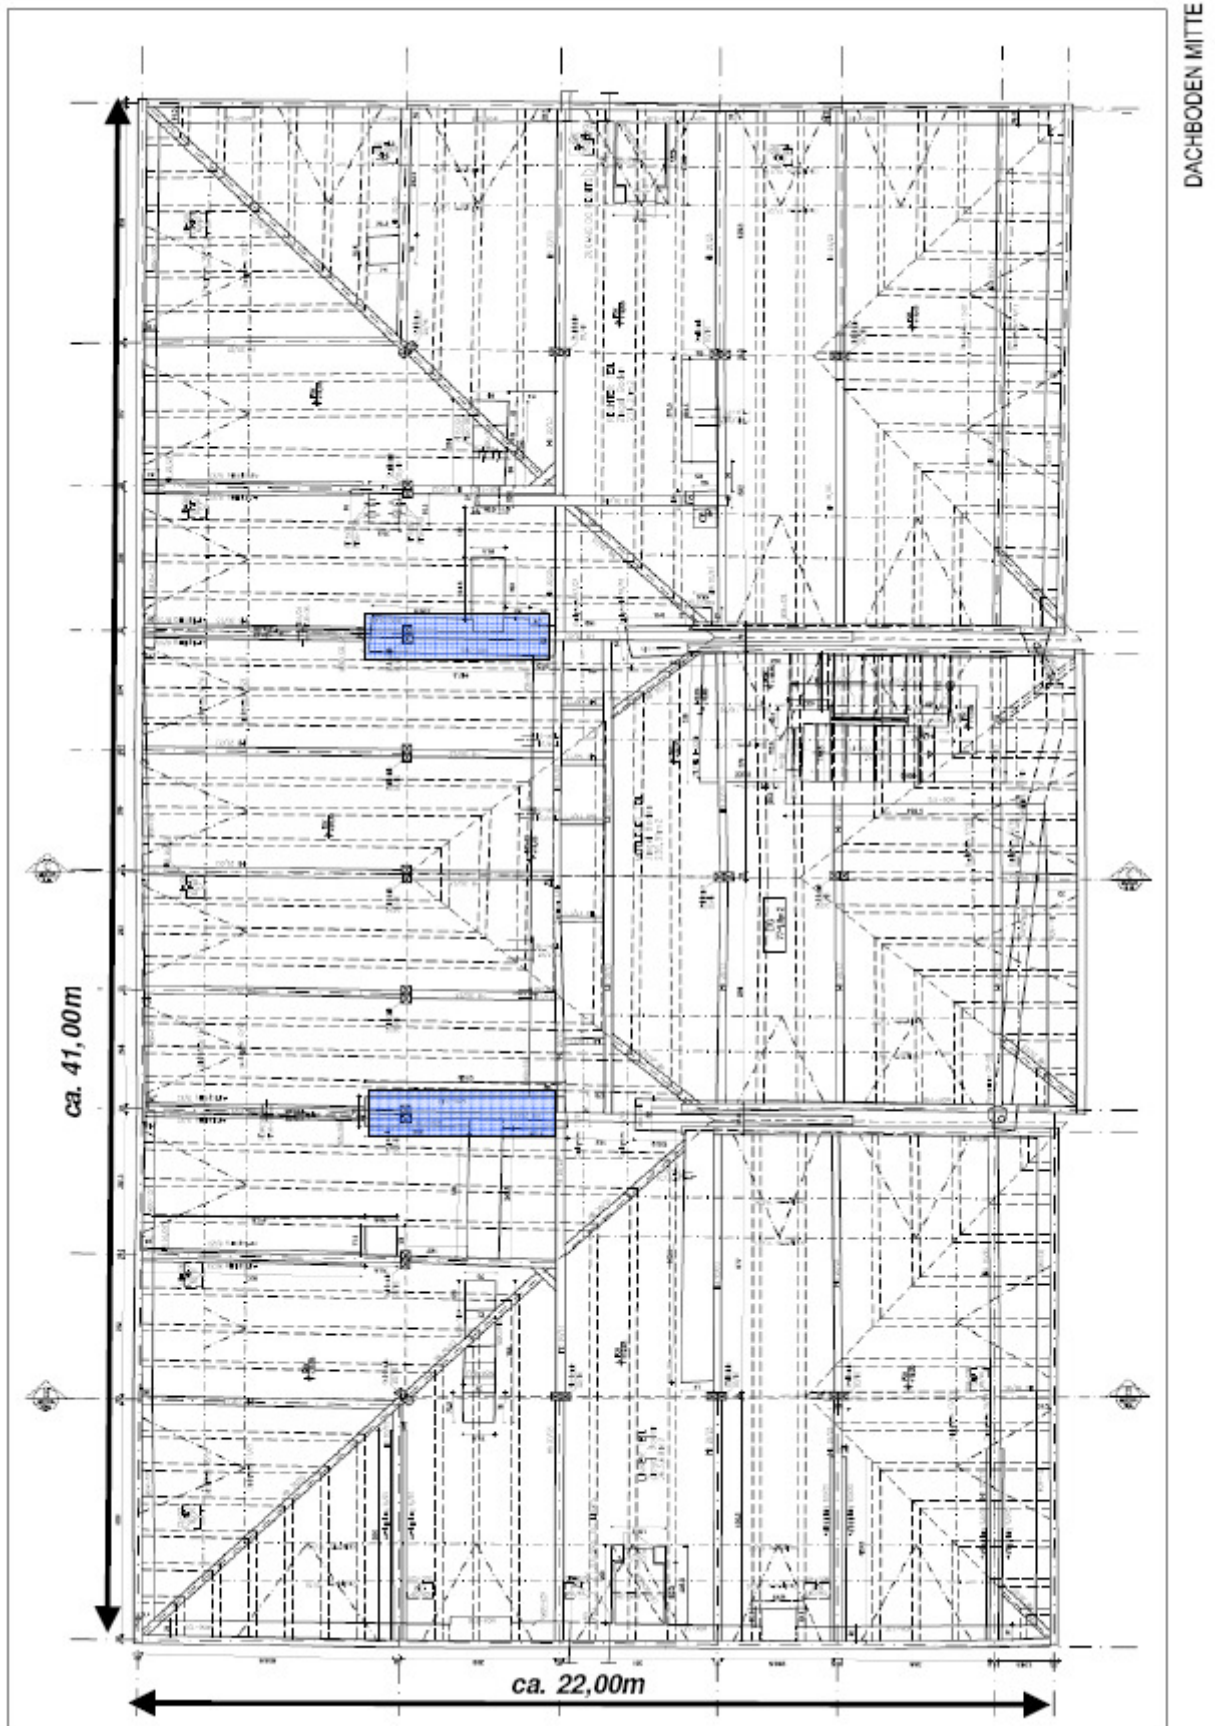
Grundriss des Barocken Dachstuhls über dem Mittelresalits des Haupttraktes
